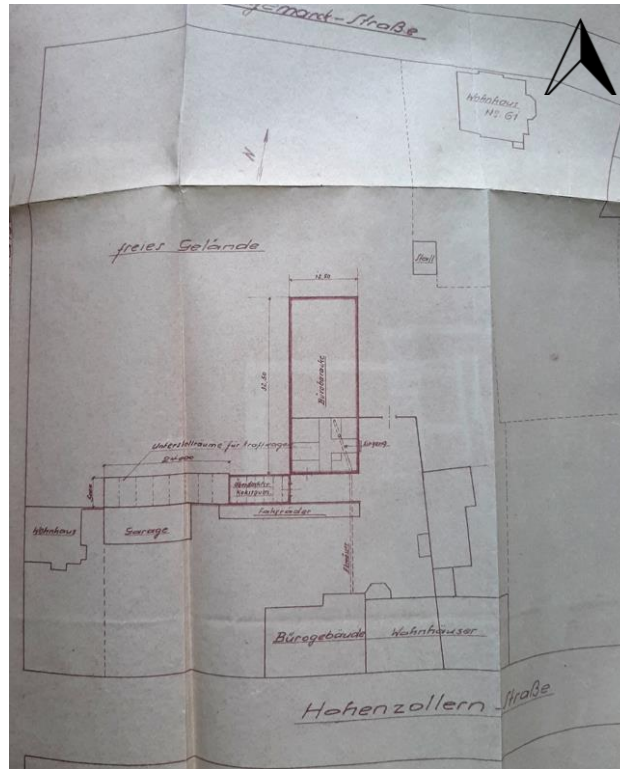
Bebauungssituation um 1942 mit der geplanten Bürobaracke
